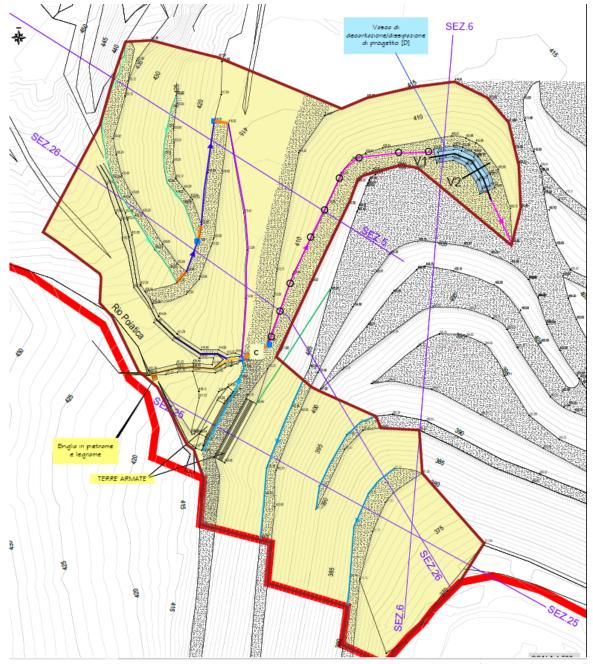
Stralcio planimetria di progetto con delimitazione area di intervento (campitura in giallo)
